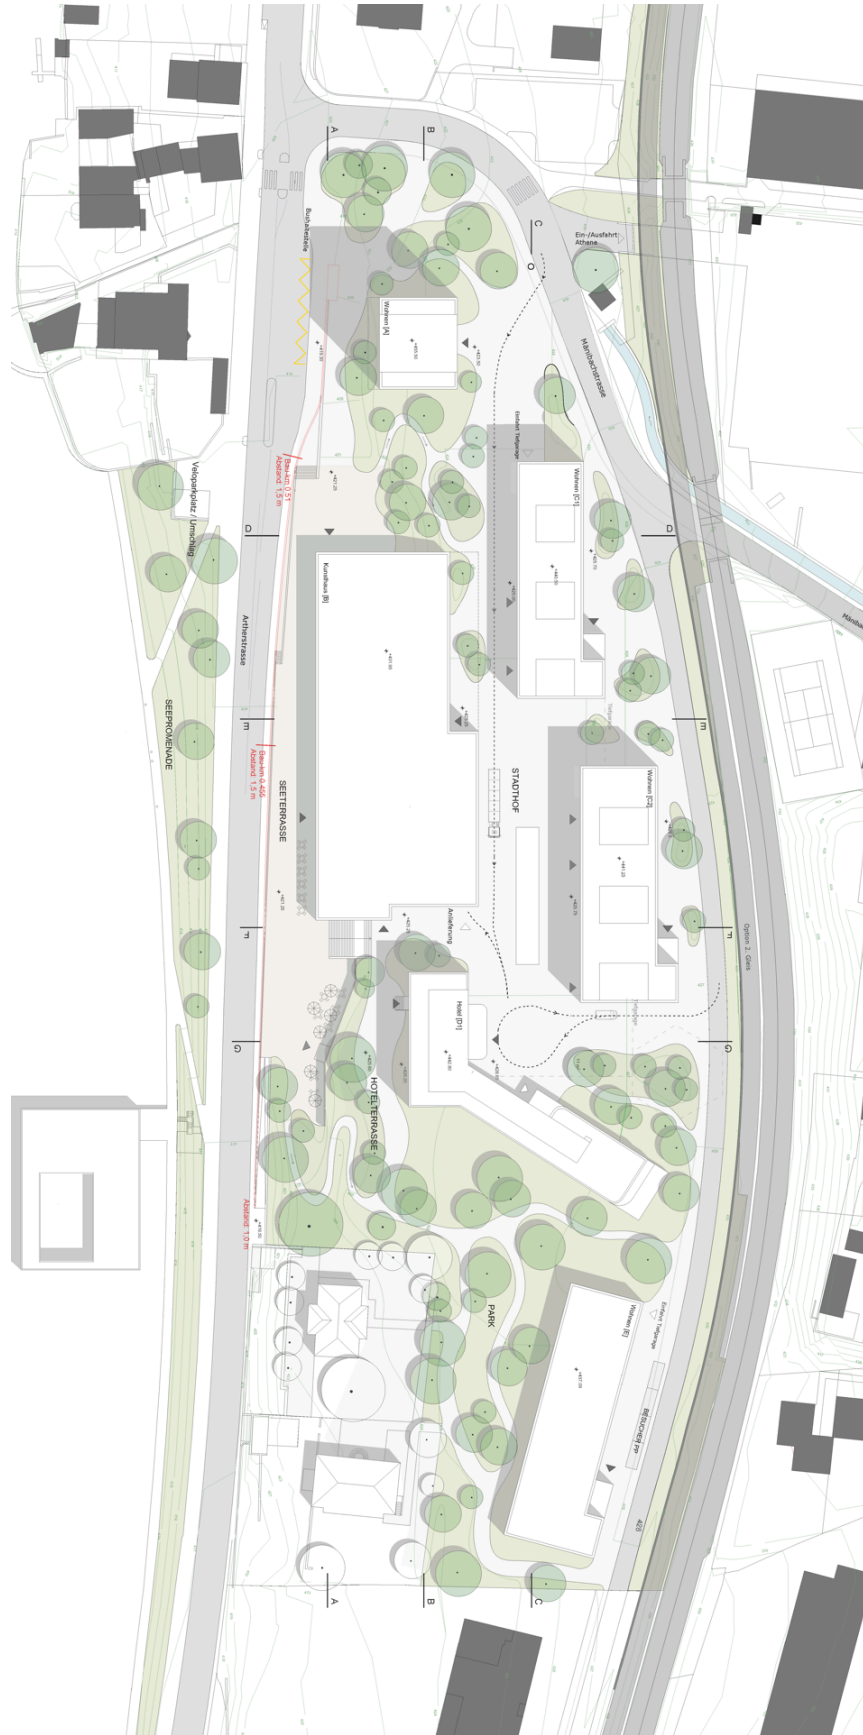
geplante Bebauung Altes Kantonsspital, Renzo Bader Architekten
